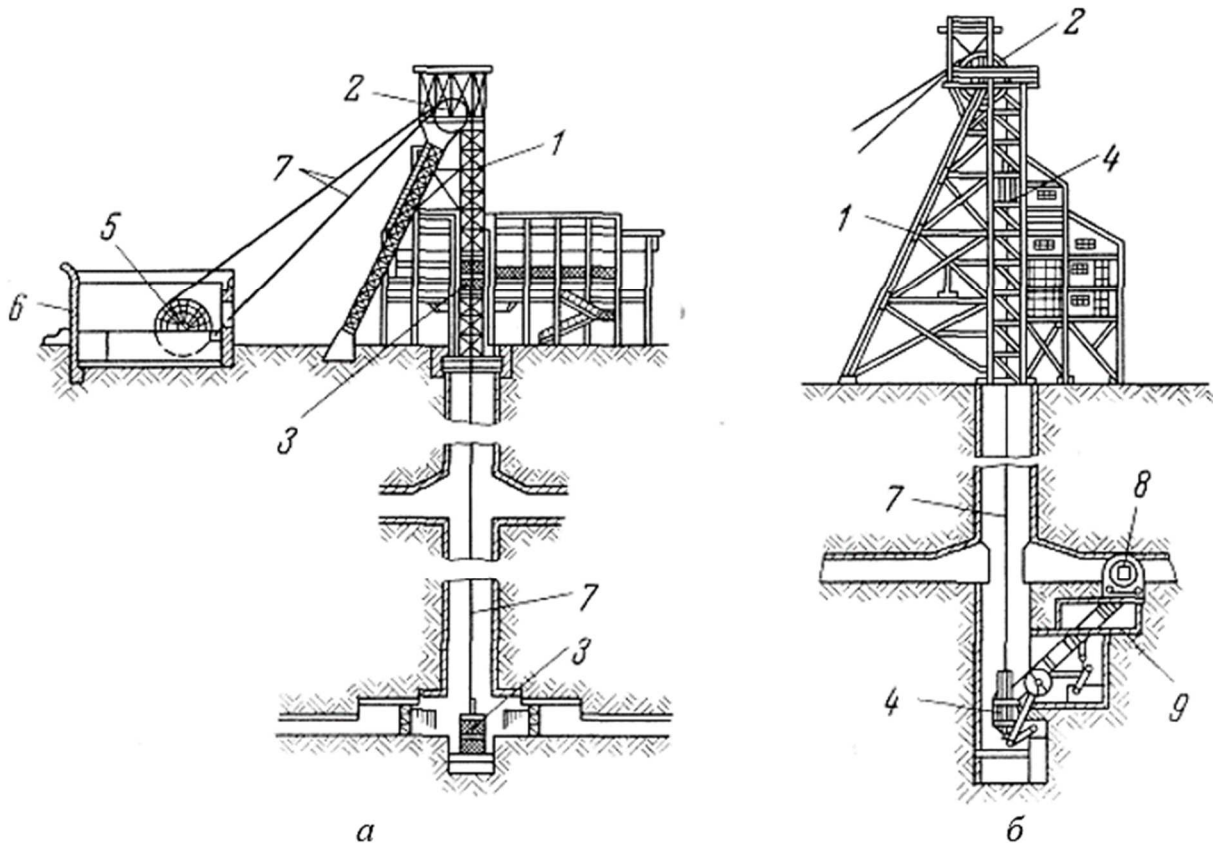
Схемы подъемных установок для вертикальных стволов:
